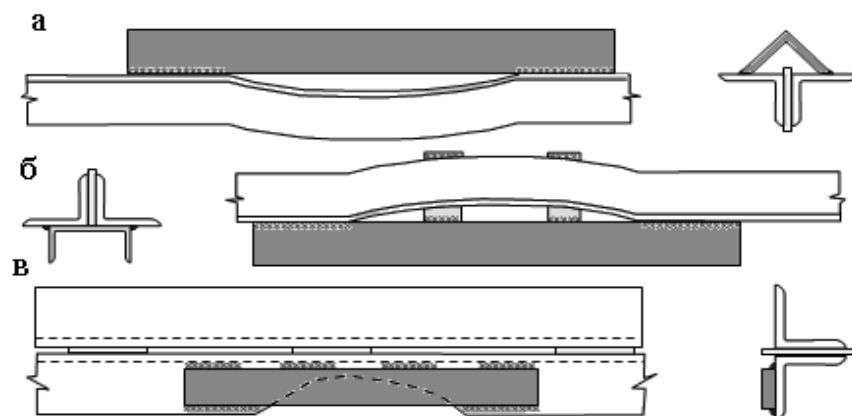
Усиление элементов стальных конструкций, имеющих повреждения, накладками: *а* – из уголка; *б* – из швеллера с дополнительными соединительными планками; *в* – из пластины
